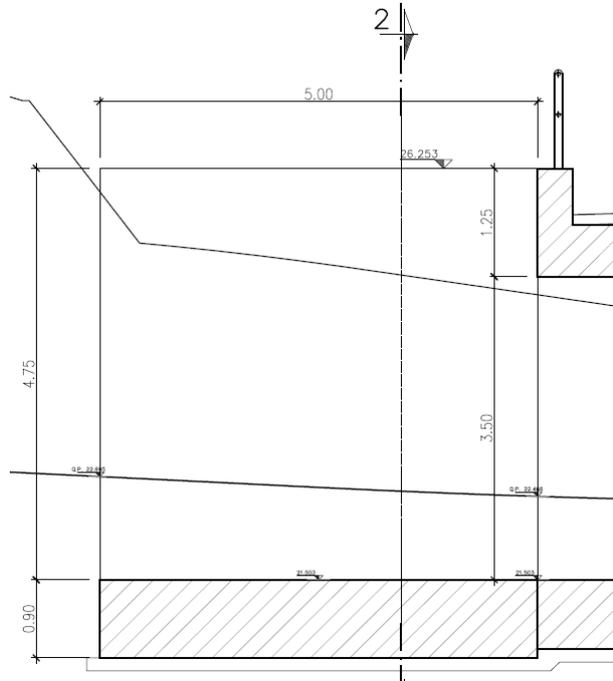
Muri di sbocco/imbocco lato Ovest - Sezione longitudinale
